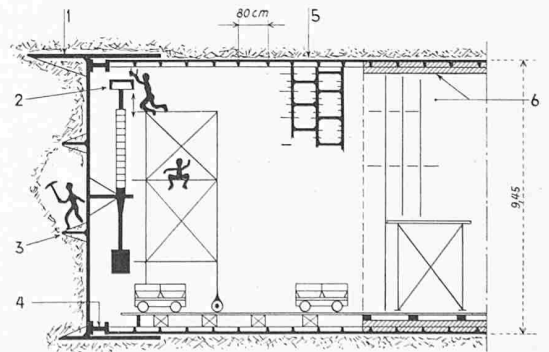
Schildvortrieb des Lincoln-Tunnels in New York, schematischer Längsschnitt 1:250. — 1 Schild, 2 Einfügen und Festschrauben der Segmente, 3 Arbeitsbühnen vor dem Schild, 4 hydraulische Pressen, 5 gusseiserne Segmente, 6 Betonauskleidung
